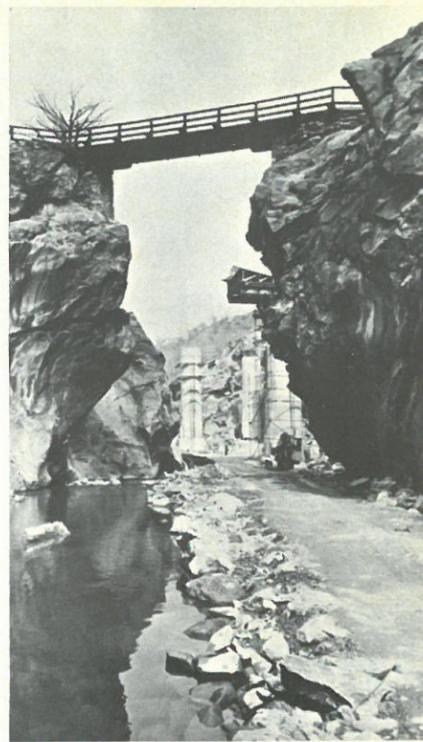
Vista del vecchio «Ponte delle Capre»; sullo sfondo pile già erette appartenenti al ponte omonimo. Notare i sottosquadri delle pareti rocciose prodotti dall'erosione del fiume.
